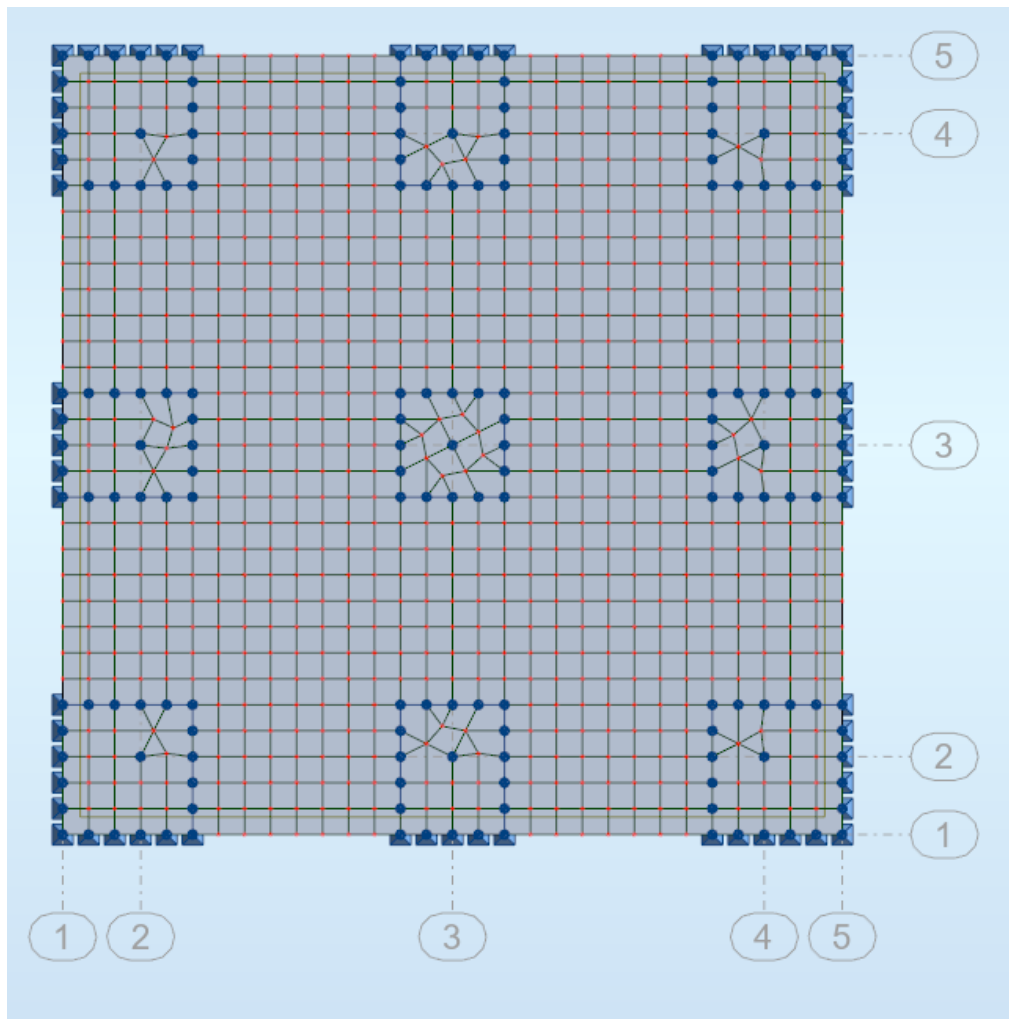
Modelo de Robot de 4 paños -vista en planta (R4P).
